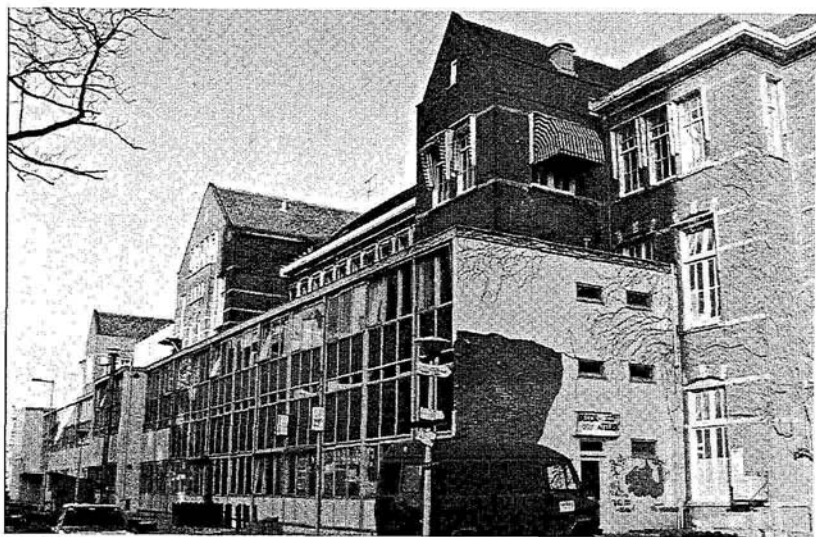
und 12: Westfassade Paviljoen 2 nach der Sanierung
